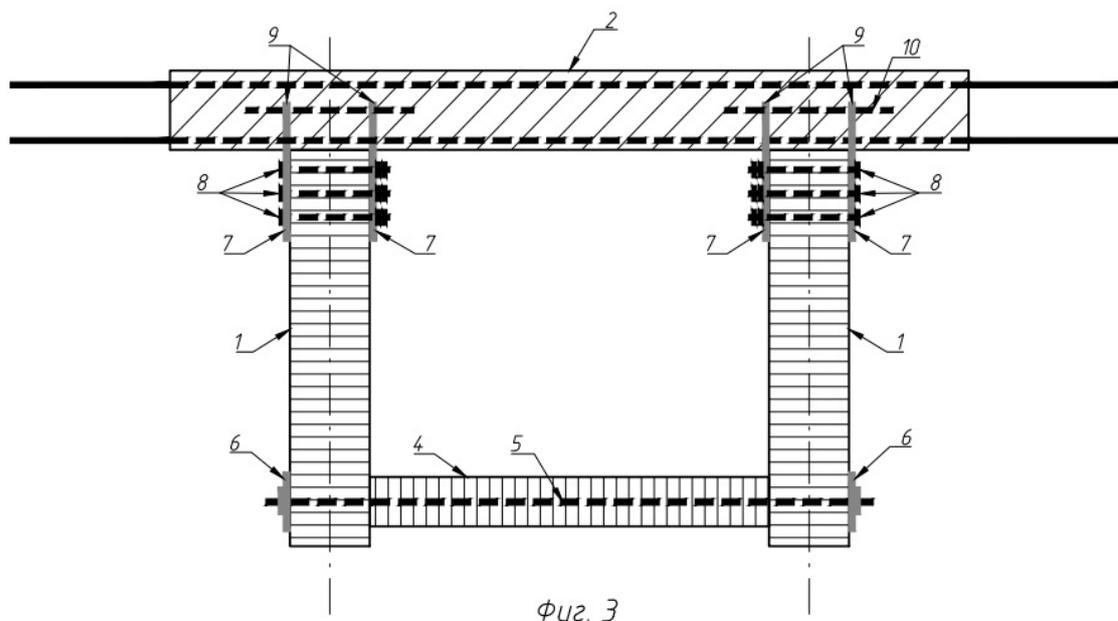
Поперечное сечение деревобетонной секции пролетного строения с узлом объединения ж.б. плиты и клееных балок. Узел Б-Б
